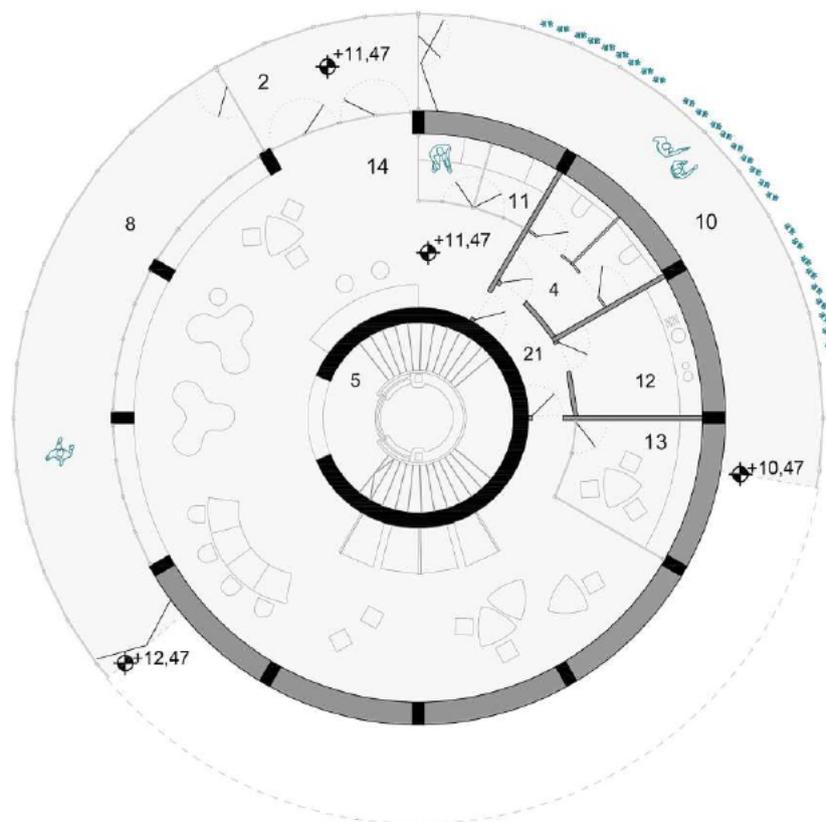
Grundriss 1.Obergeschoss
